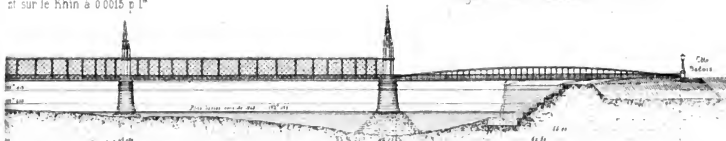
Coupe sur l'axe des poutres par GH à 0°015 p 1"
